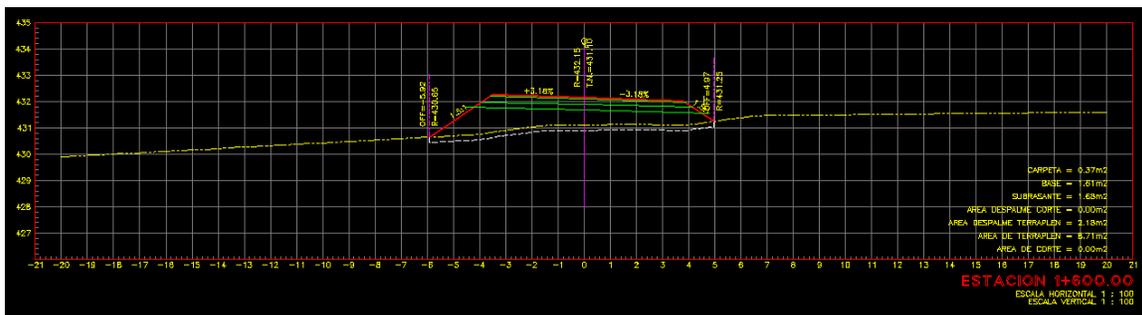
Sección transversal con capa de despalme en todo el ancho de sección.
